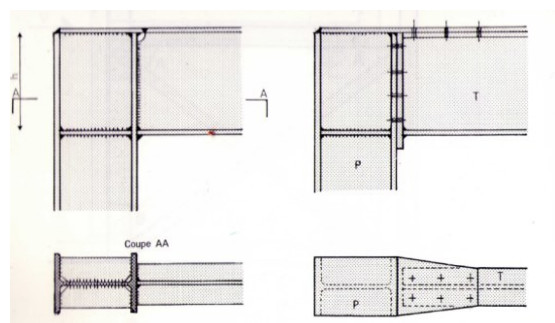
Nœuds rigides de portiques : assemblages par soudage (à gauche) et boulonnage (à droite)
